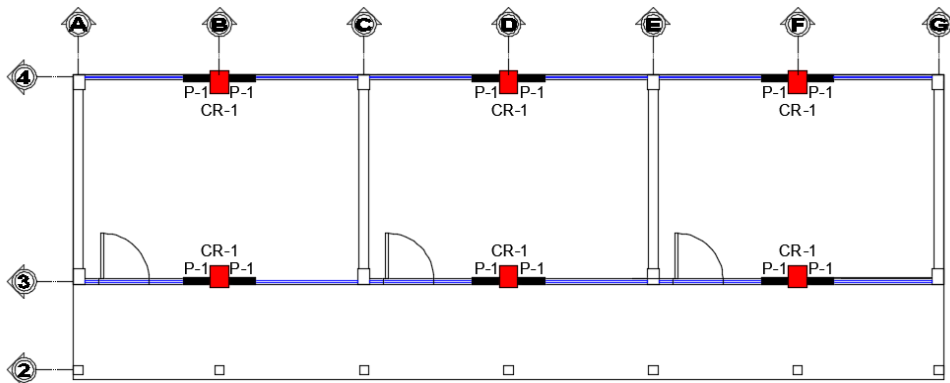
Pabellón P-3: Vista en planta de la estructura reforzada
